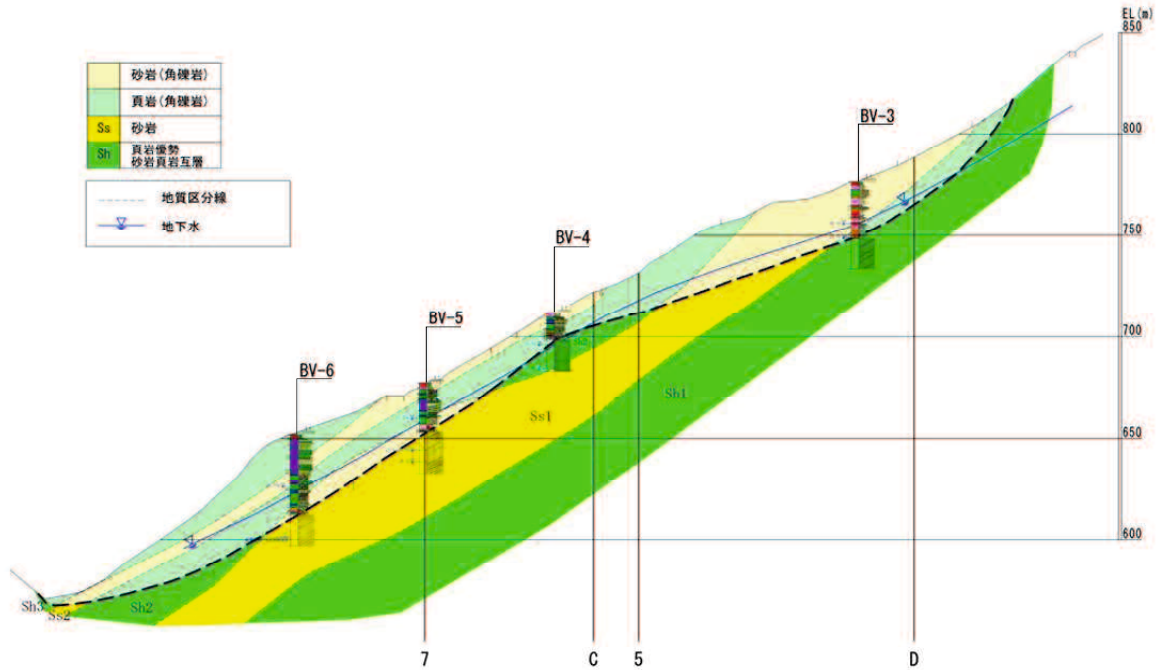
二畝の谷斜面の地質断面図 (d断面)
